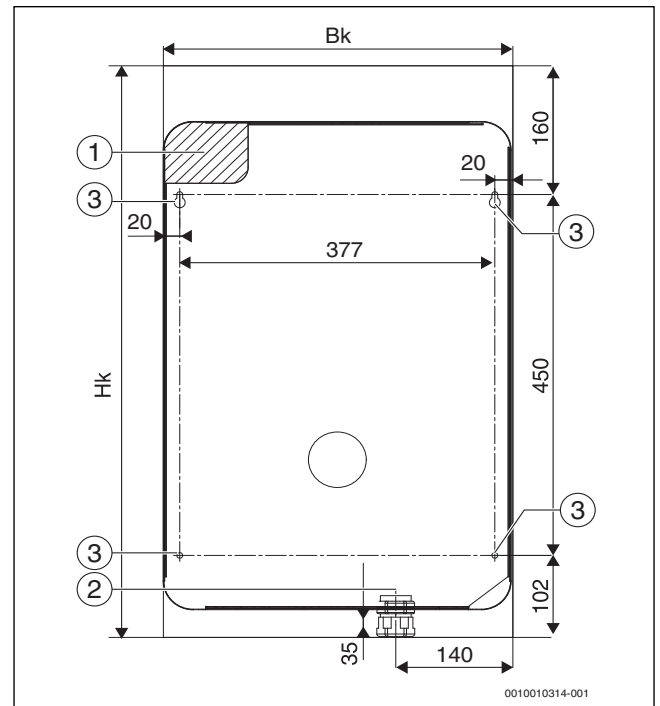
Abmessungen der Bohrungen für das Befestigen des Heizkessels an der Wand und für das Versorgungskabel beim Heizkessel Tronic Heat 3000 15-24 kW
